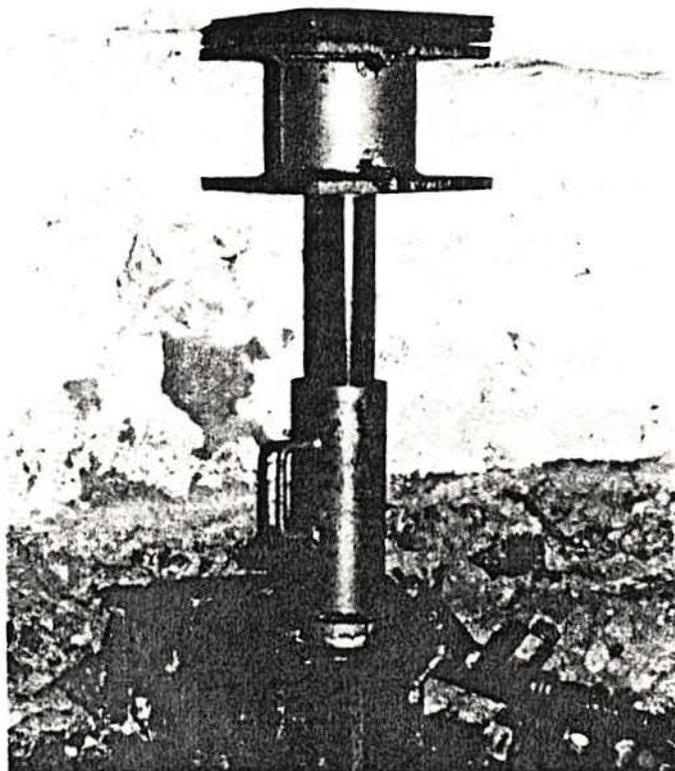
Reforço de fundação através da incorporação de estaca mega metálica
